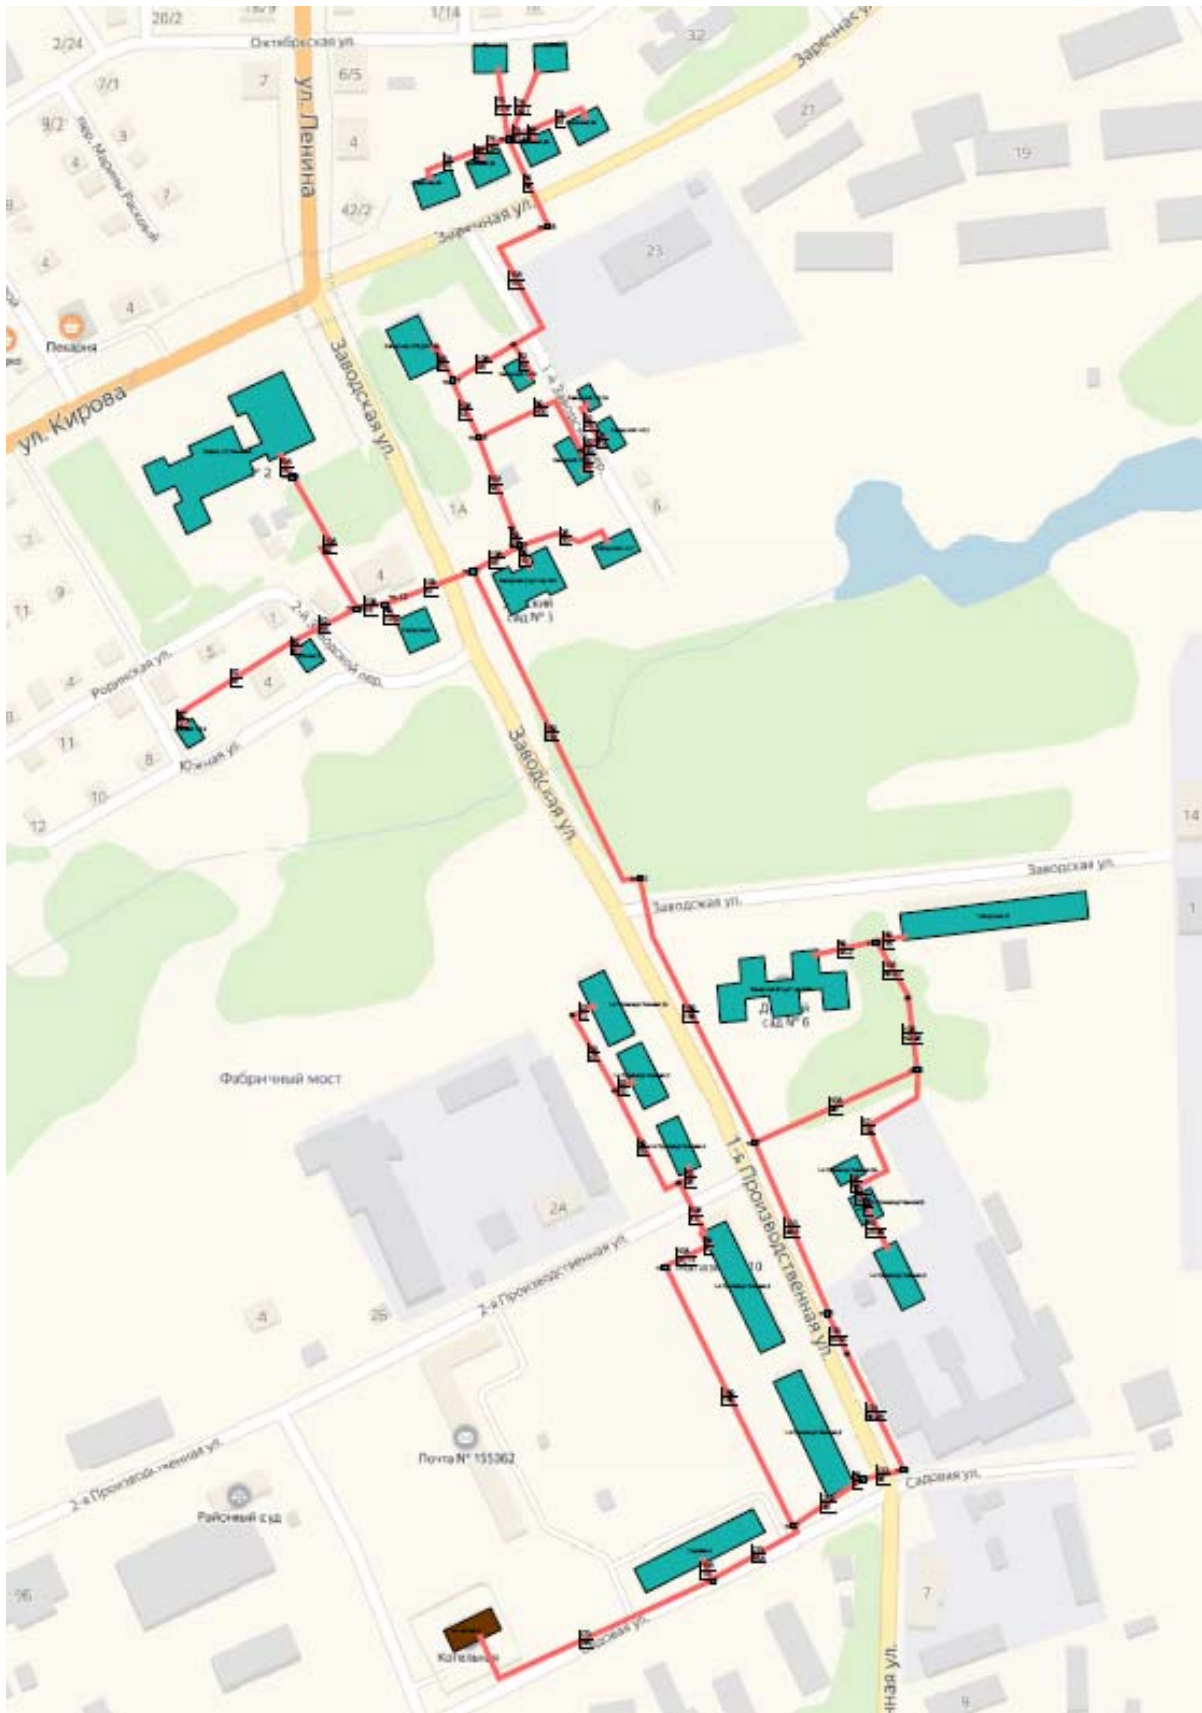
Схема тепловых сетей котельной № 9 БМК 5,1 МВт ул. Садовая
